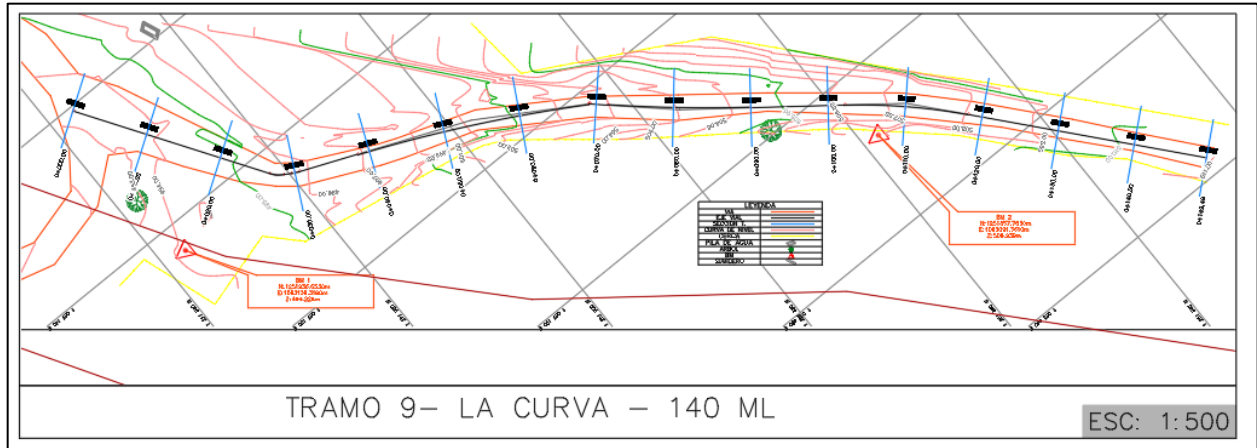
Imagen de planta del tramo 9 del proyecto de San Vicente de Chucuri-Santander
